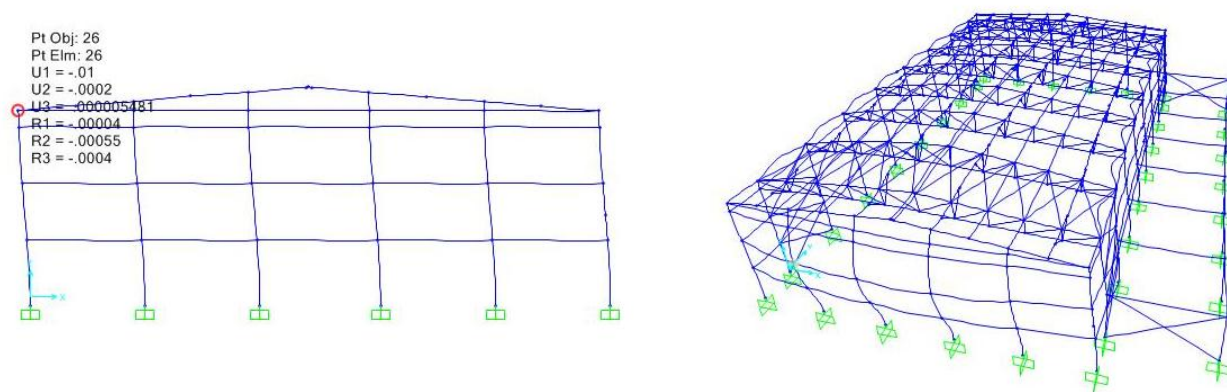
Deformada de la estructura bajo la acción del viento Vx2b (SAP2000).
